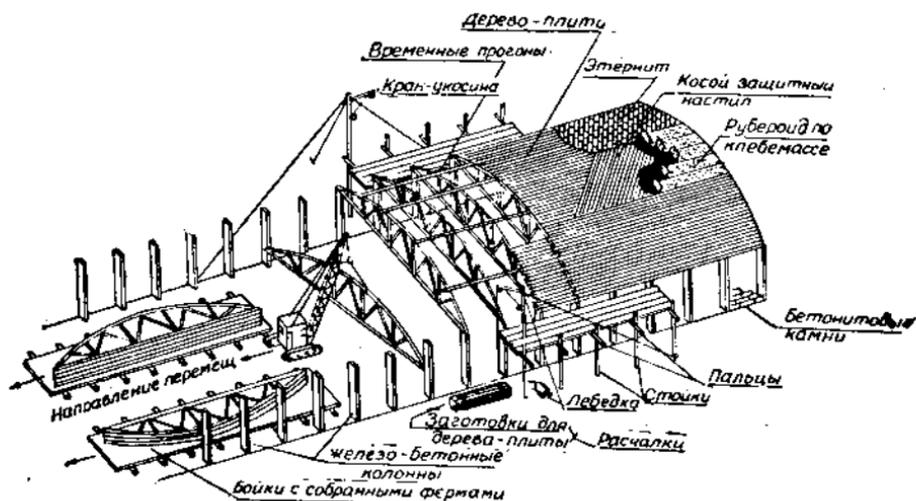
Подъем и установка сегментных ферм и раскрепление их прогонами.
